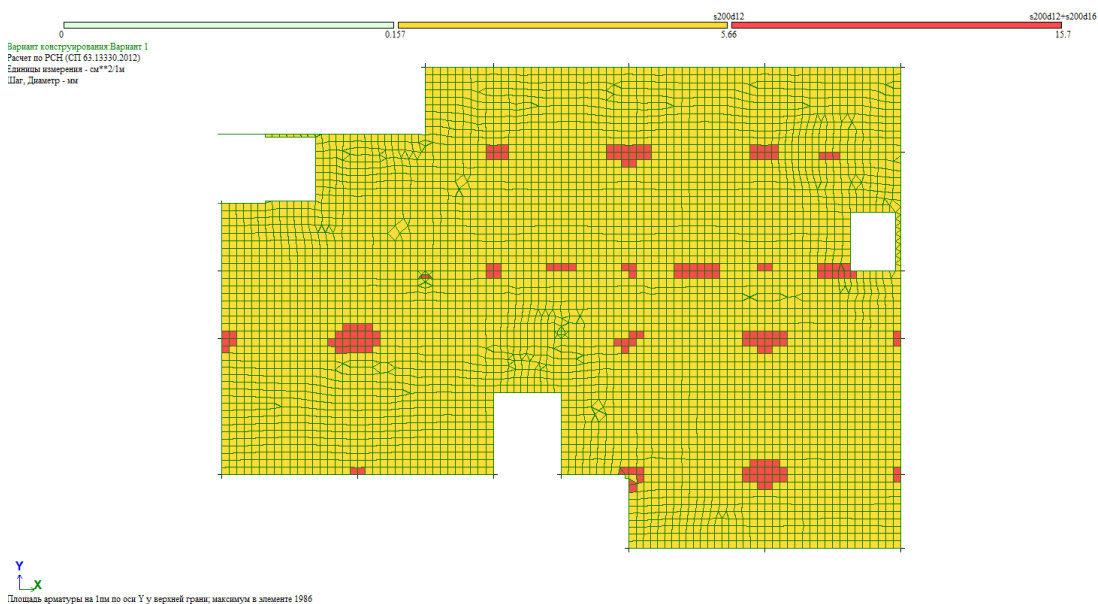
Площадь арматуры на 1мм по Y у верхней грани
